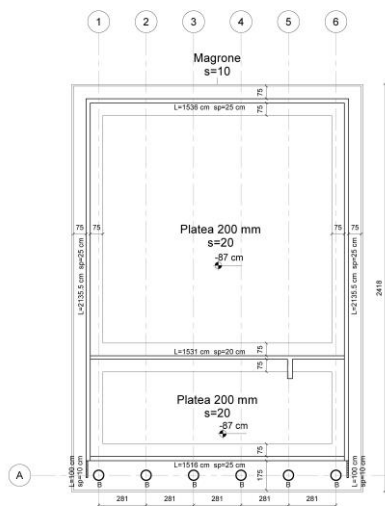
Edificio C (Auditorium): Pianta fondazioni
